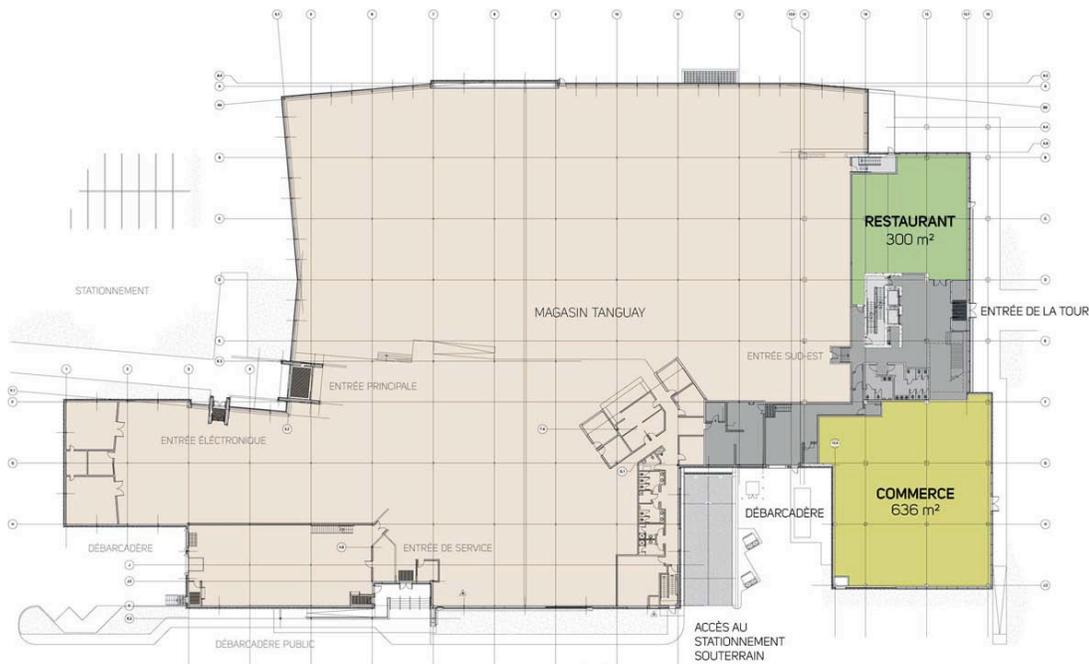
Plan du rez-de-chaussée (Source : Coarchitecture, 2011)
